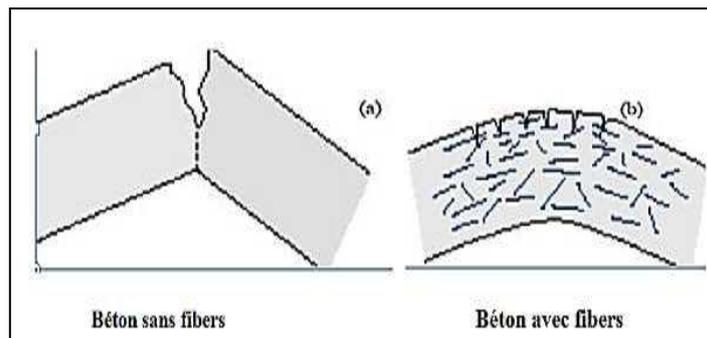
Fissuration dans le béton sans et avec fibres [39].
